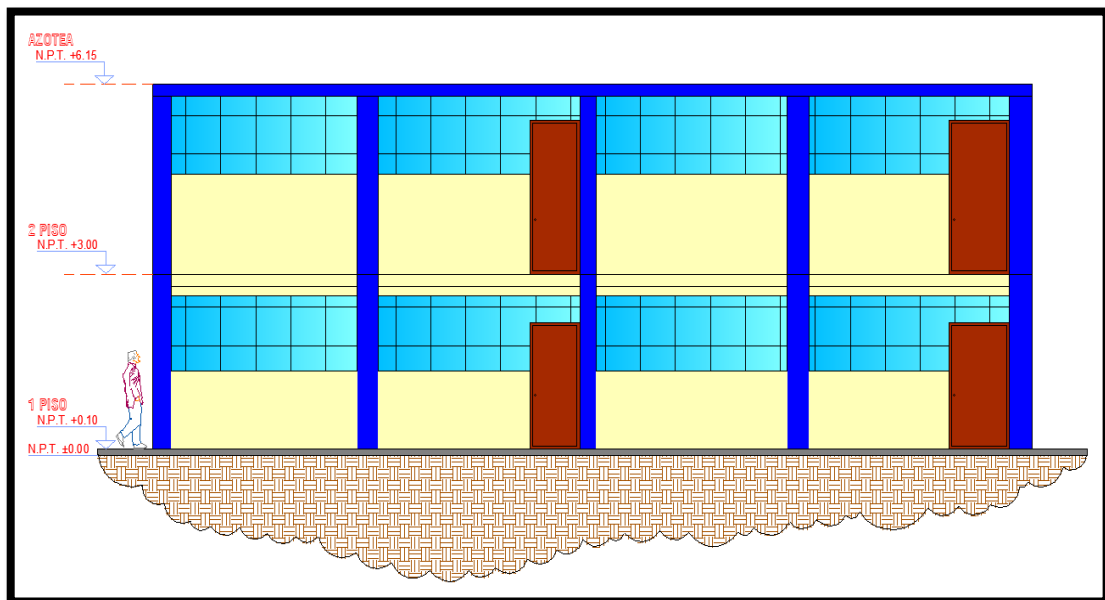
Plano de elevación corte eje: 2-2/A-E - vista frontal del pabellón “C”
